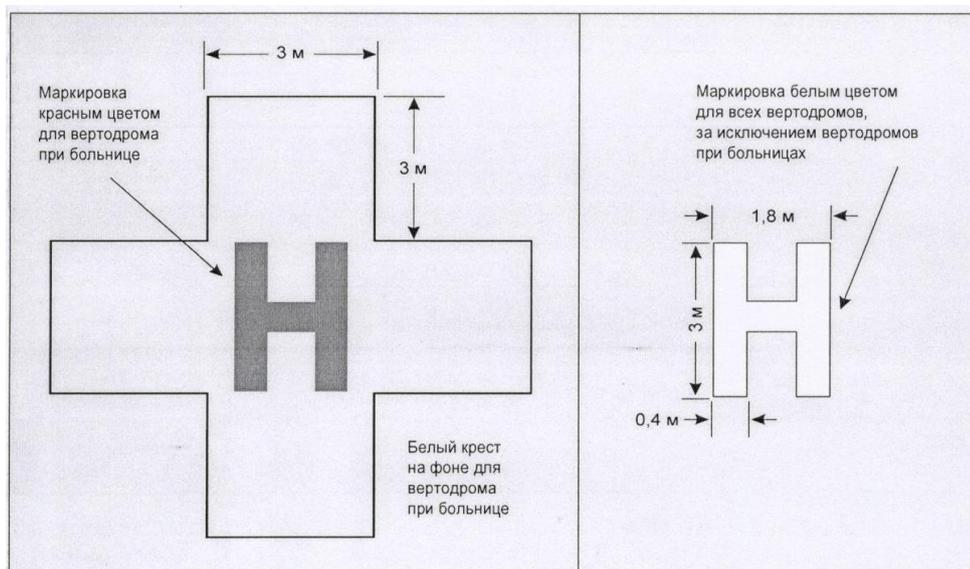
Опознавательная маркировка для вертодрома и вертодрома при больнице
